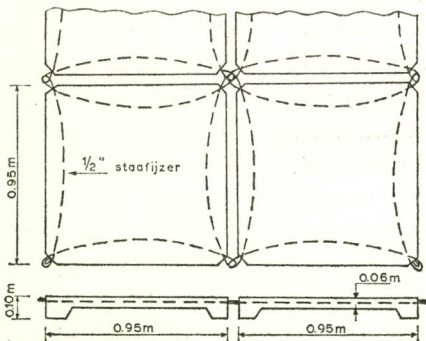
Elementen van een betonnen zinkstuk systeem „de Muralt”.
